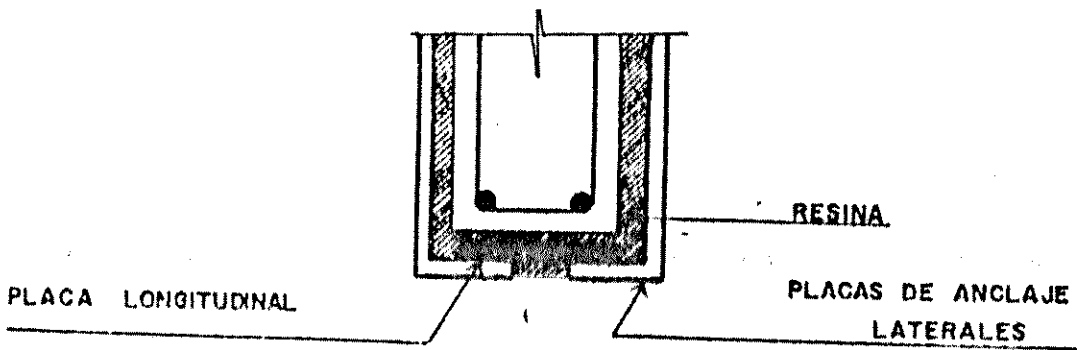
Refuerzo de una viga mediante placas longitudinales de anclaje y resina epóxica.
